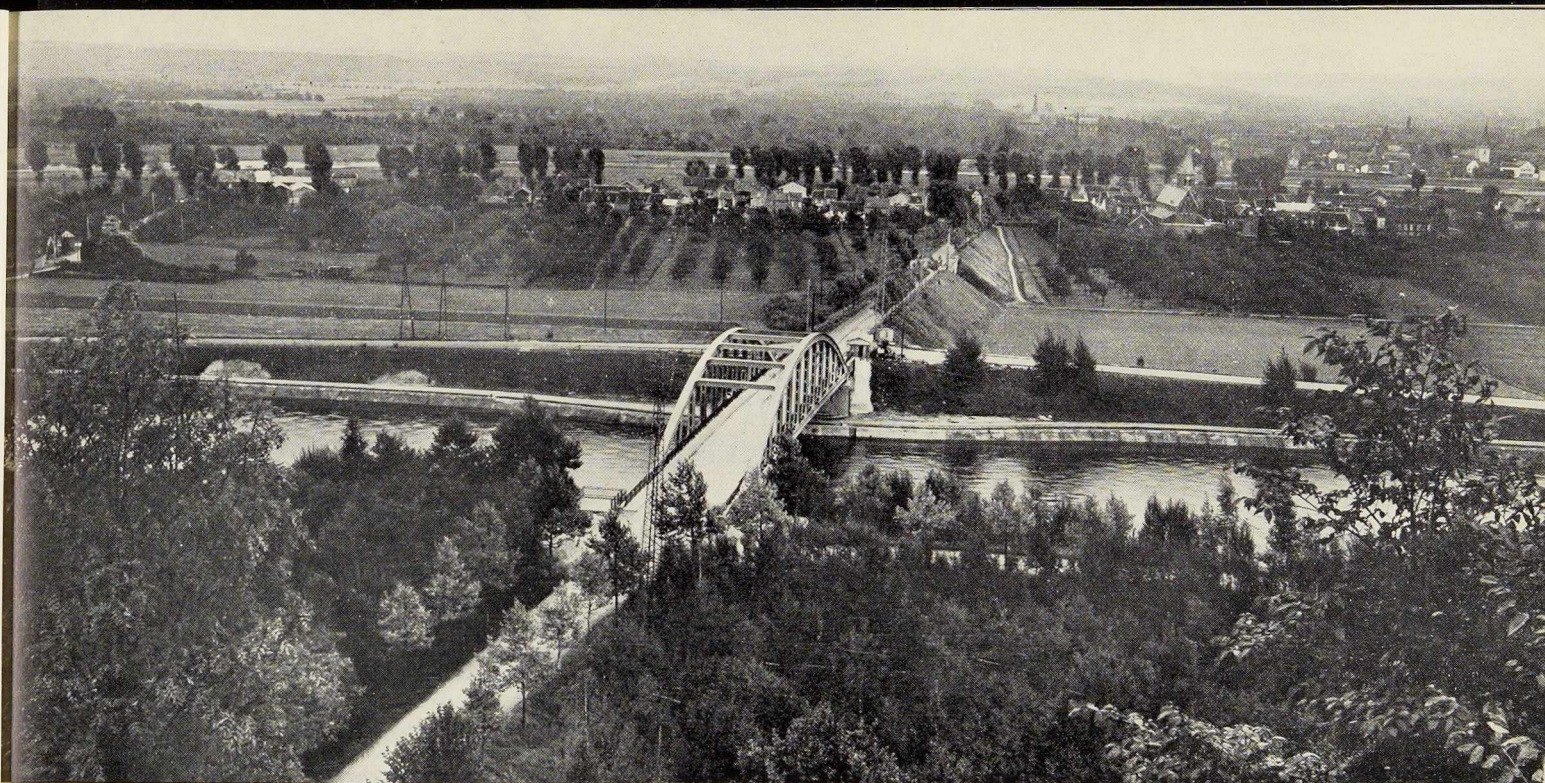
Vue d'enfilade du nouveau pont de Lanaye sur le Canal Albert.
